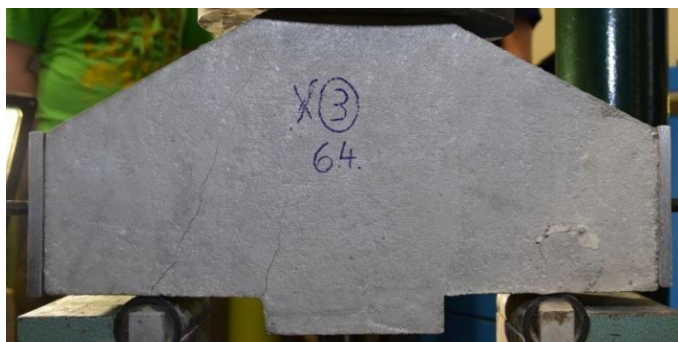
Zdeformovaný vzorek vyztužený betonářskou výztuží
